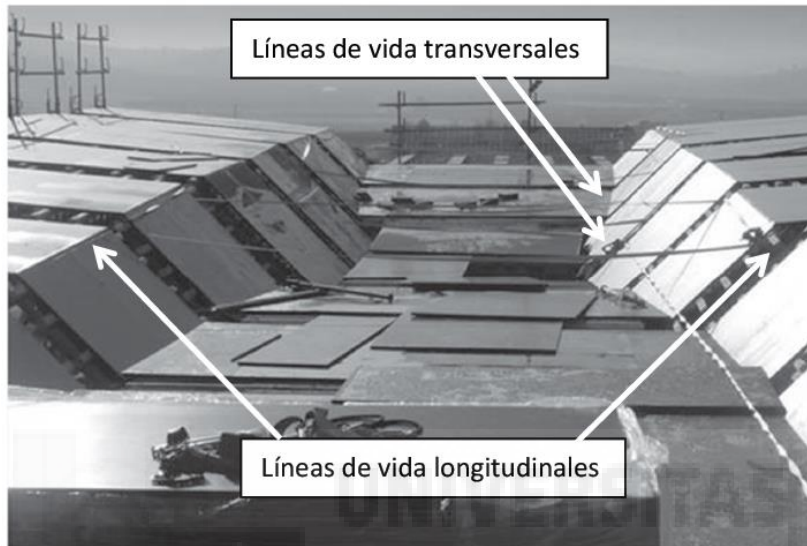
Vista de los barcos colocados sobre las torres de cimbra con las barandas y las líneas de vida
